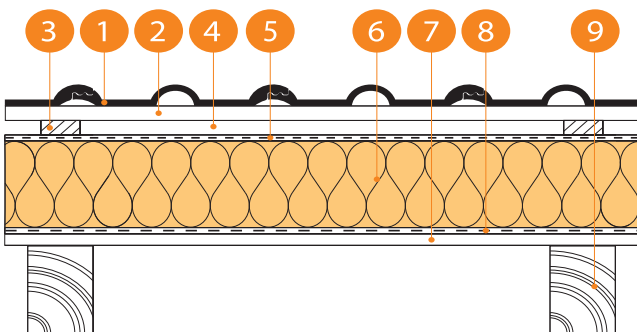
Кровли с размещением слоя теплоизоляции в межстропильном пространстве, вариант 1
